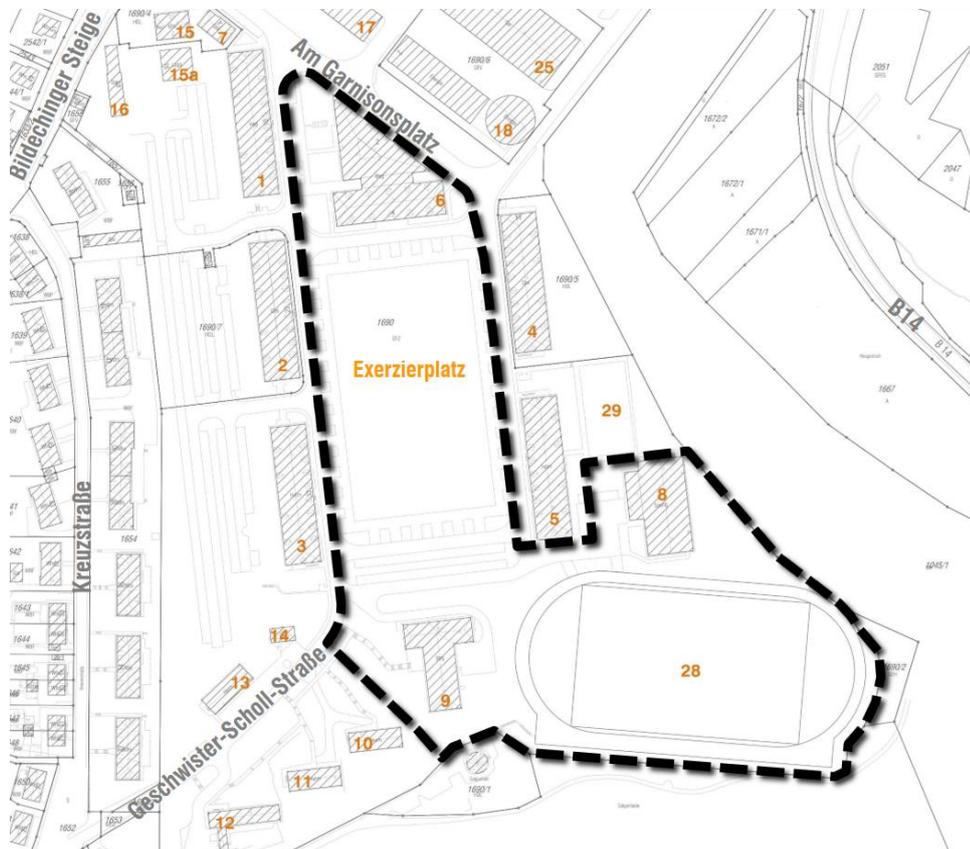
Übersicht Gebäudenummerierung, Nachvollzug Beschreibung Nutzungen
